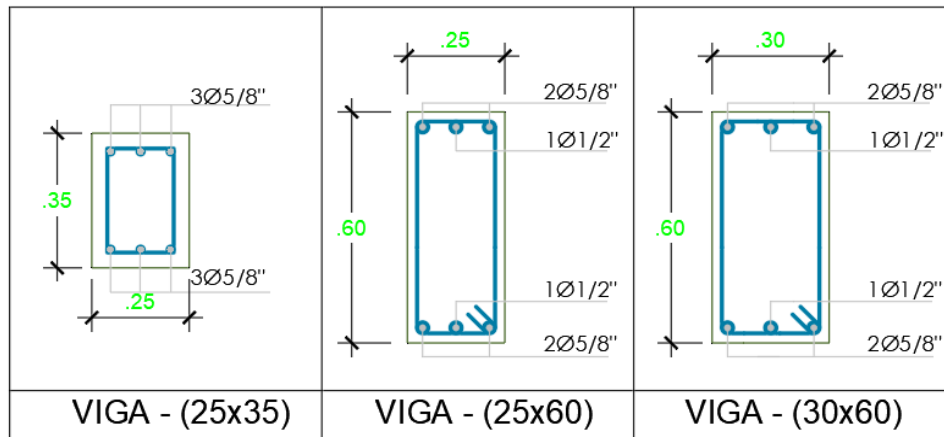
Secciones transversales de vigas Piso 1, Bloque 2
